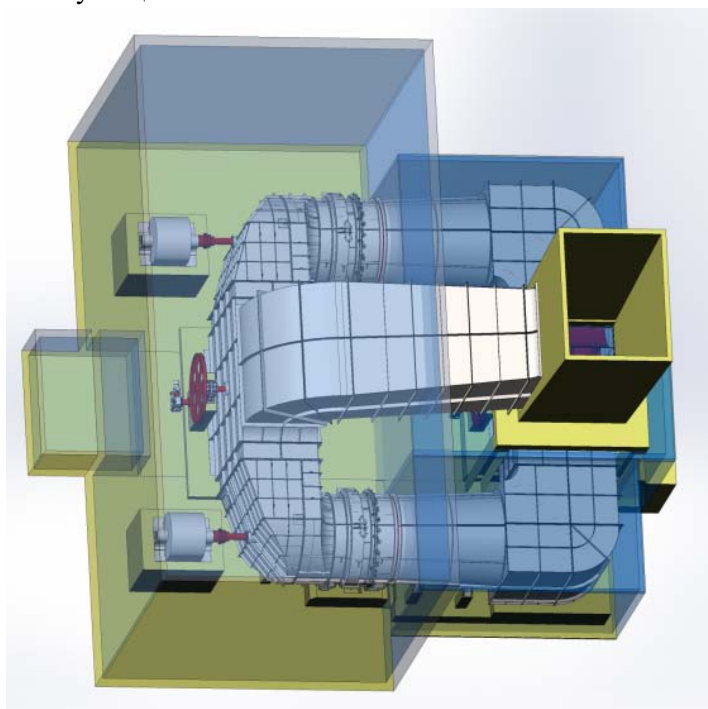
Компактная вентиляторная установка в здании и с укрытиями
